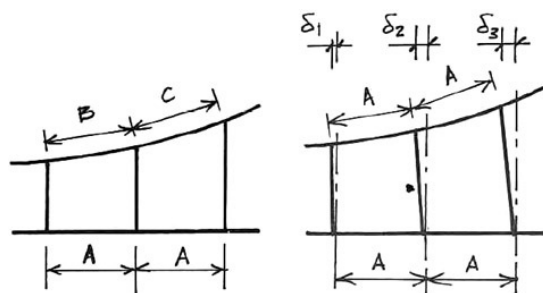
Solución de cubierta con vigas de luces constantes debido al ángulo introducido en la grilla de pilares. Ilustraciones extraídas de "Lille Grand Palais: Zenith/Congres/Expo; Architects: Rem Koolhaas" (Mc Gowan et al., 1995, p.22).
